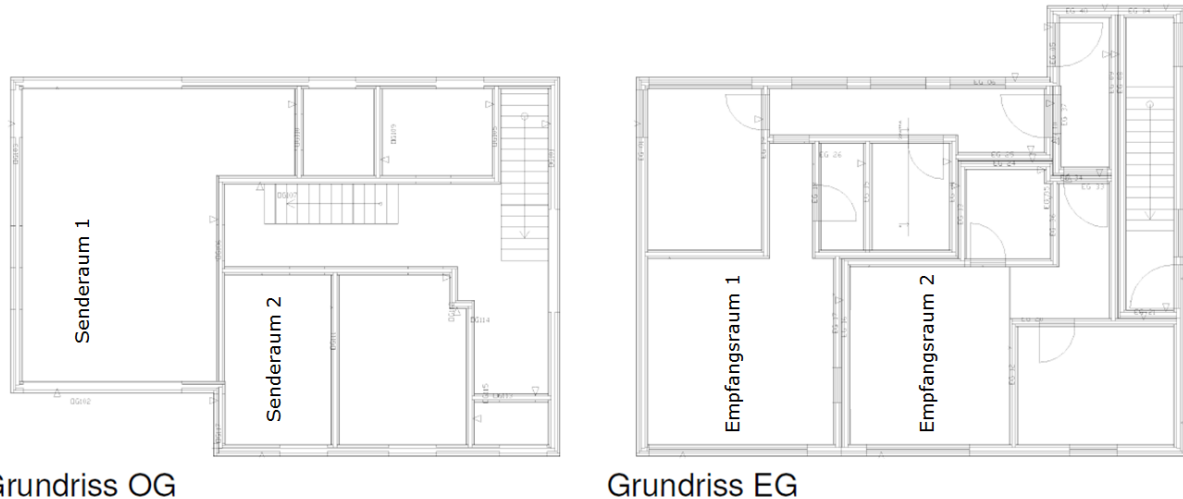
Grundrisse der Etagen mit den Positionen für die Schallmessungen
